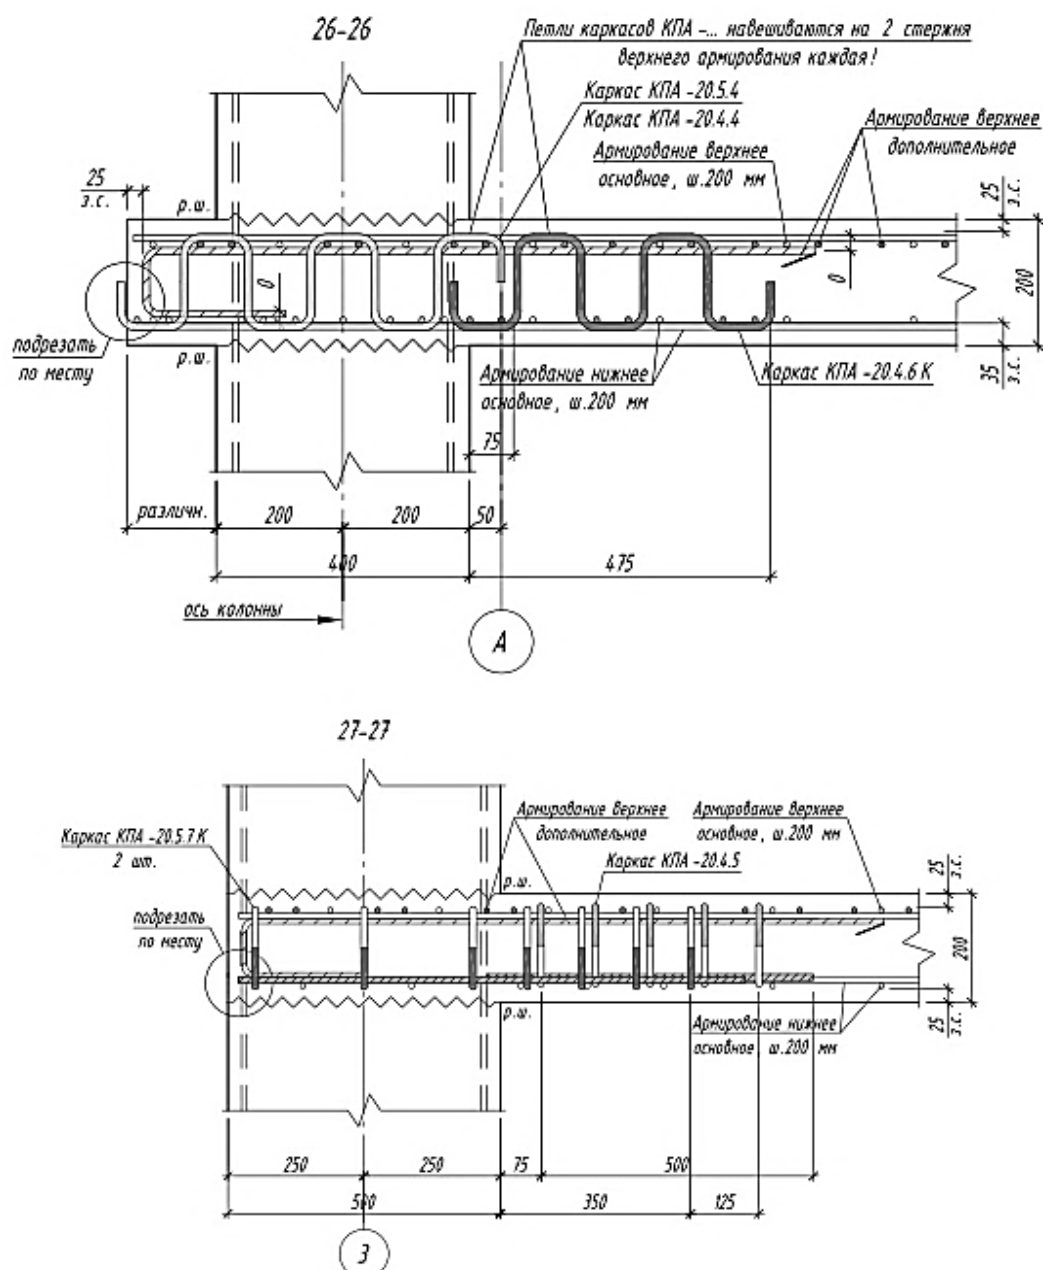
Узел поперечного армирования плиты перекрытия типового этажа
